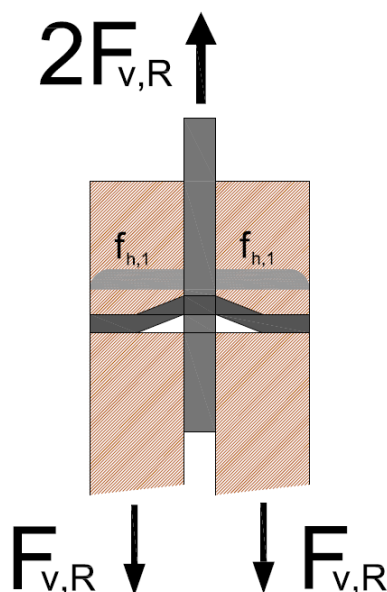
Modo de rotura 3 – ligações madeira-aço em corte duplo. Faria (2009).
